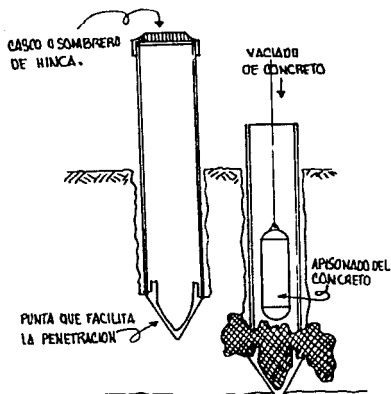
PILOTE SIMPLEX (LAS DOS FASES).
